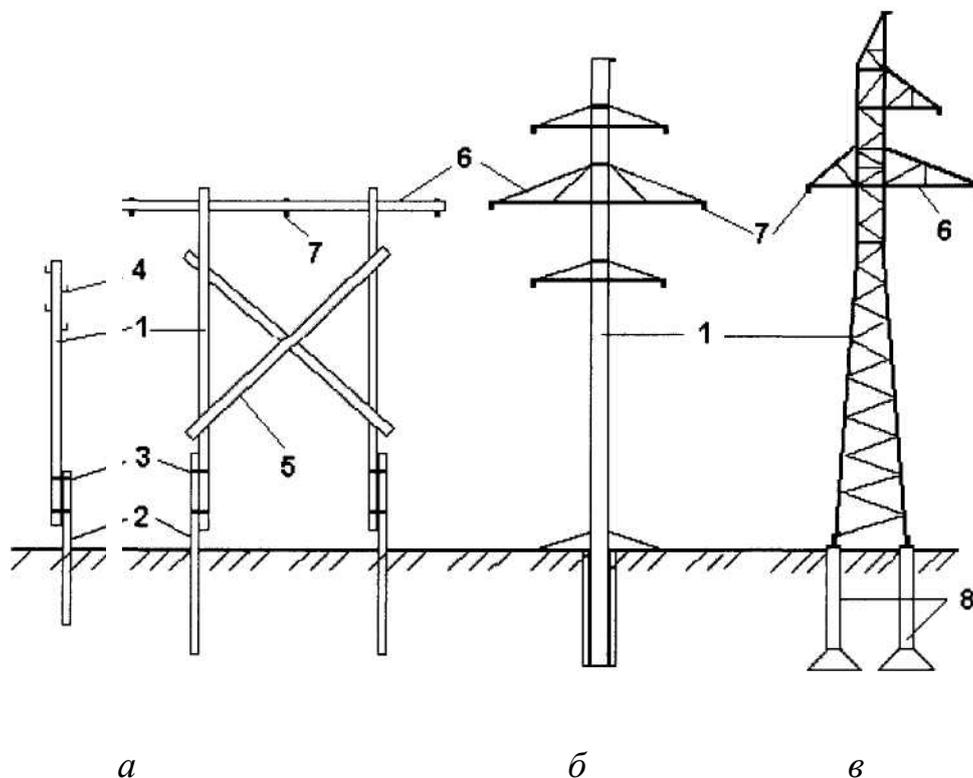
Деревянные (а), железобетонная (б) и стальная (в) опоры ВЛ: 1 - стойка опоры; 2 - железобетонная приставка (пасынок); 3 - бандаж из стальной проволоки или стальной хомут; 4 - крючья для армировки изоляторов; 5 - раскосы для жесткости; 6 - траверсы; 7 - сцепная арматура для крепления гирлянды изоляторов; 8 - железобетонные фундаменты.
